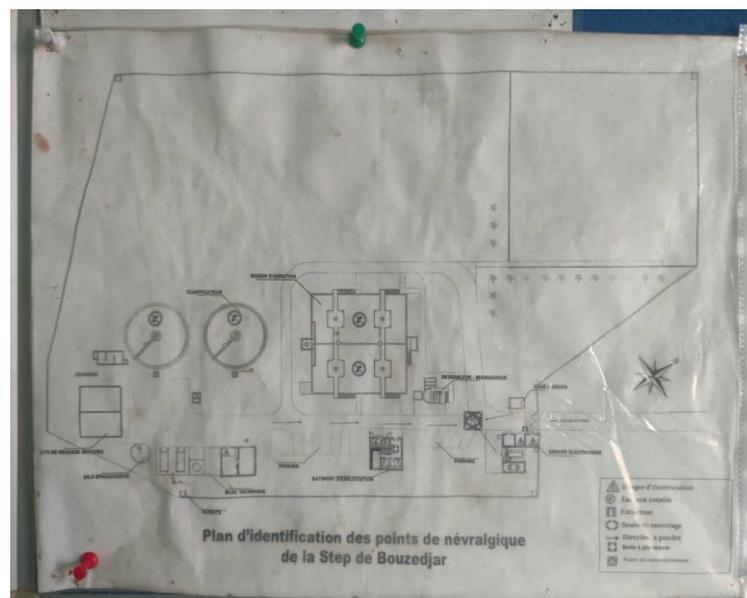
9 : Plan d'évacuation vers le point de rassemblement
